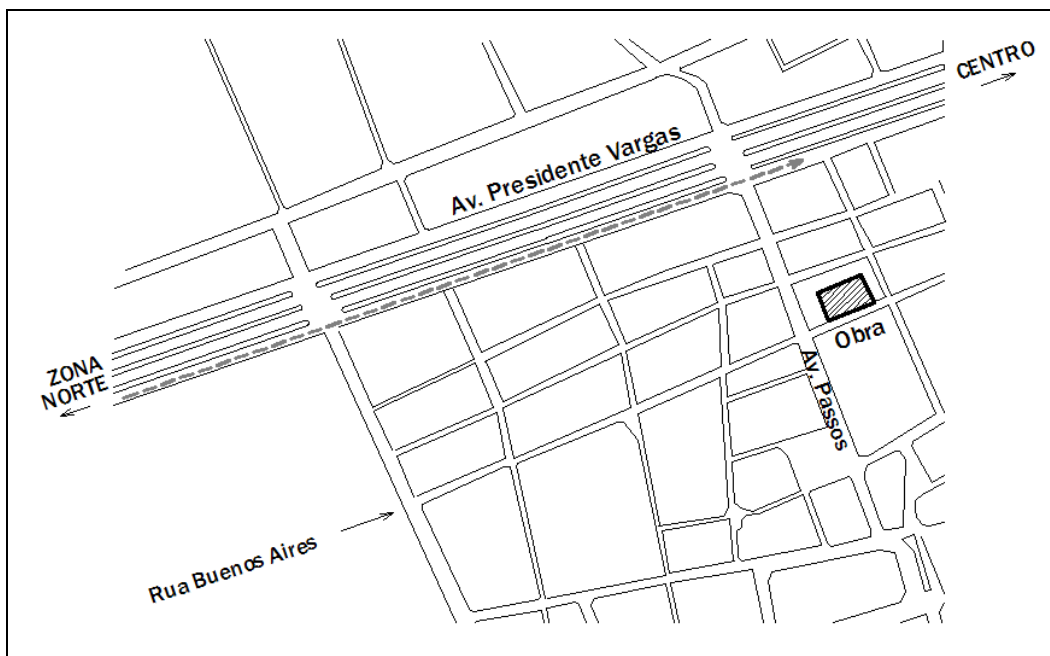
Planta com locação da Av. Presidente Vargas e da obra.
